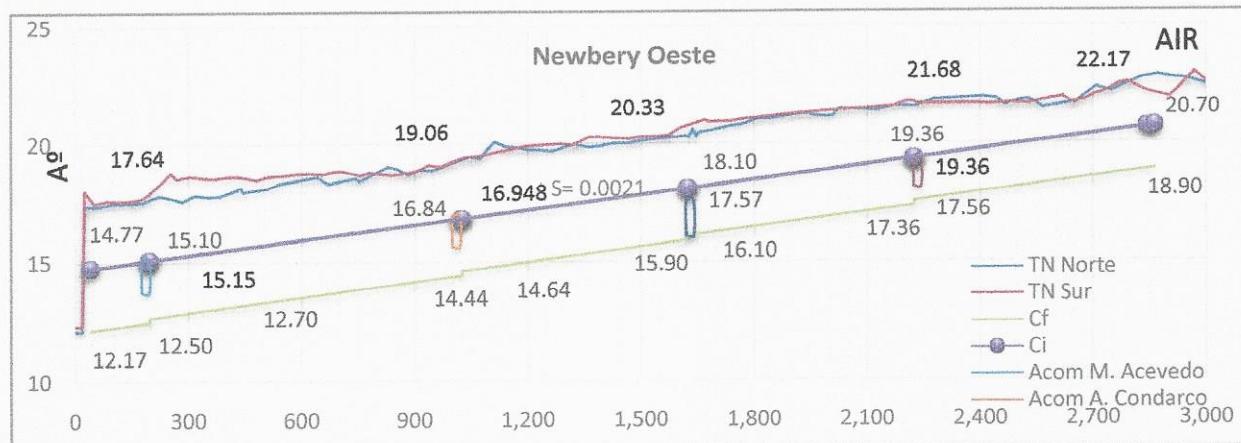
Perfil longitudinal Emissario Newbery Oeste
